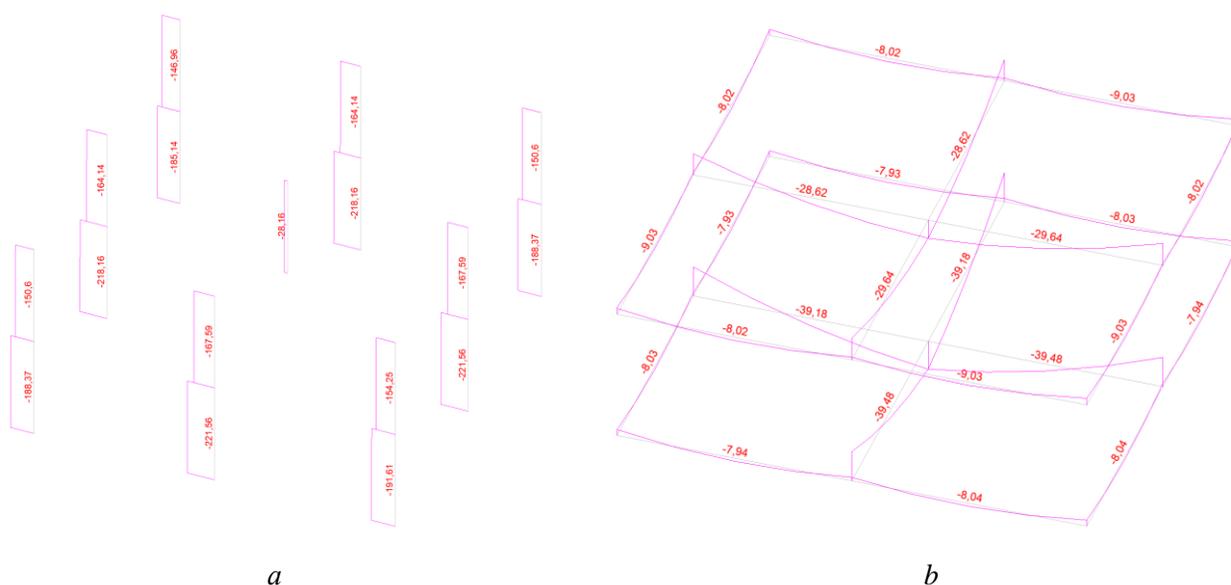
Распределение усилий в элементах колонн и балок при удаленной колонне с нагрузками, соответствующими установившейся расчетной ситуации: *a* — продольные усилия; *b* — изгибающие моменты
